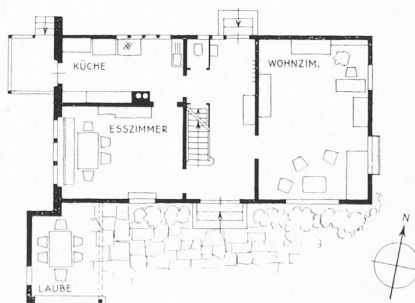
bis 3. Grundrisse des Hauses Dr. E. Laur in Thalwil (Zürich). — Masstab 1 : 300
